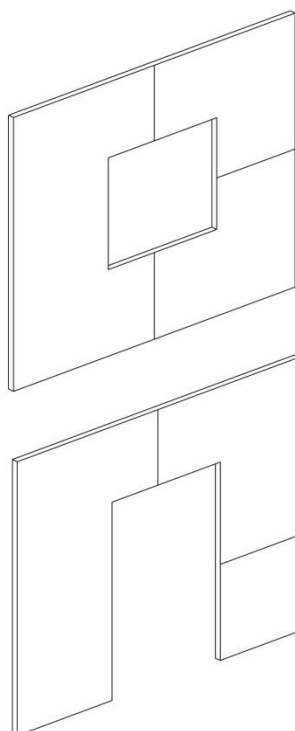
Placas cimentícias em vãos de portas e janelas
